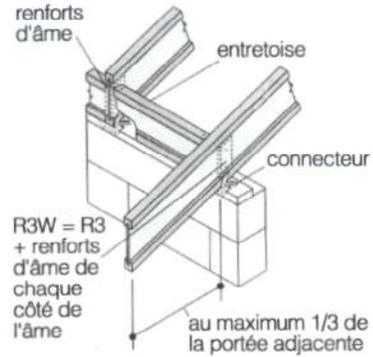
Appui d'une ferme traditionnelle sur le mur de façade
